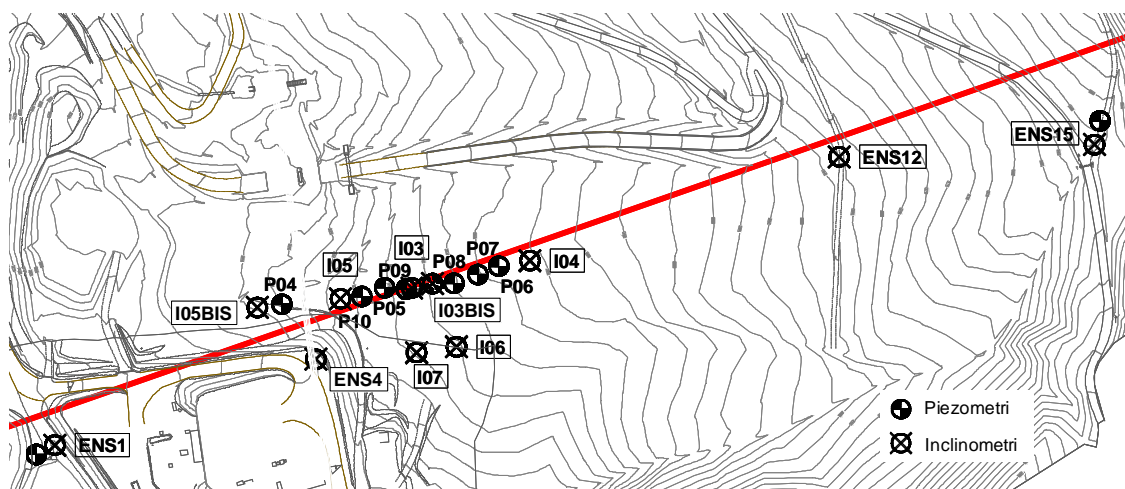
Pianoro: planimetria dell'area in frana e ubicazione delle indagini (Olmedo 2007)
